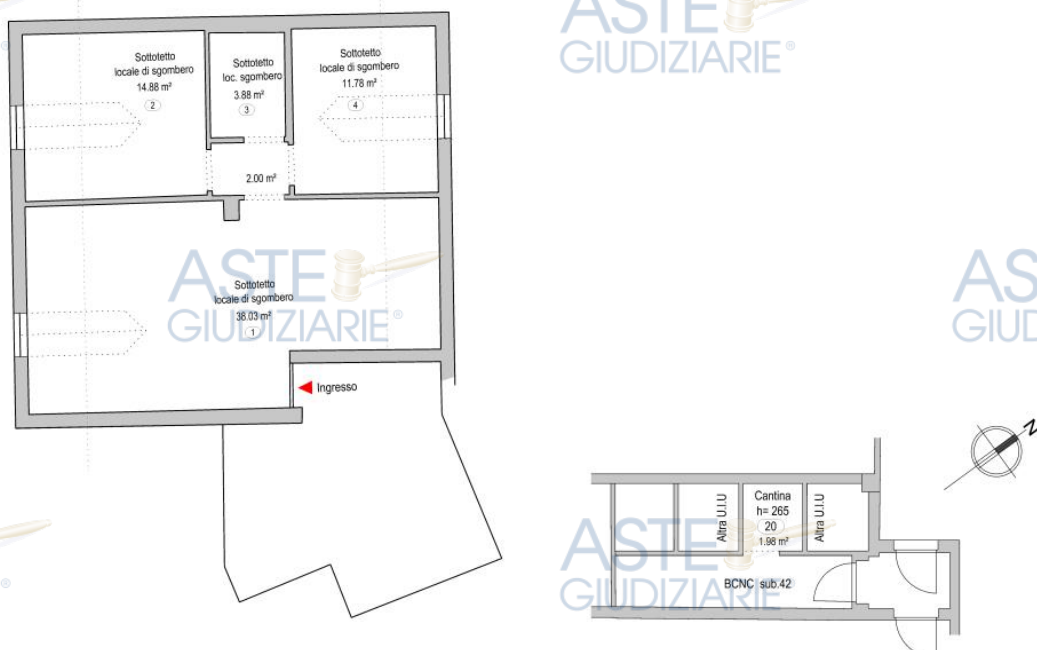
Planimetria subalterno n.20 (piano secondo e piano interrato). Si rimanda all'Allegato A per elaborato in scala
